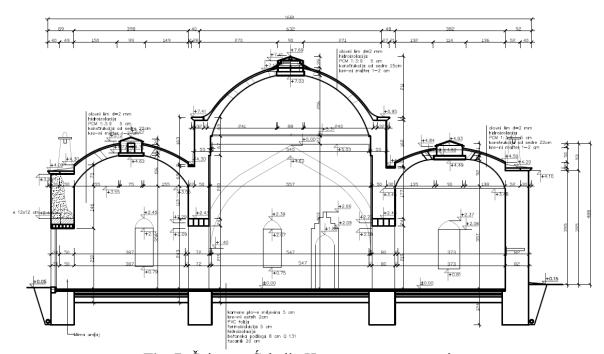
Čejvan – Ćehajin Hammam – cross-section
